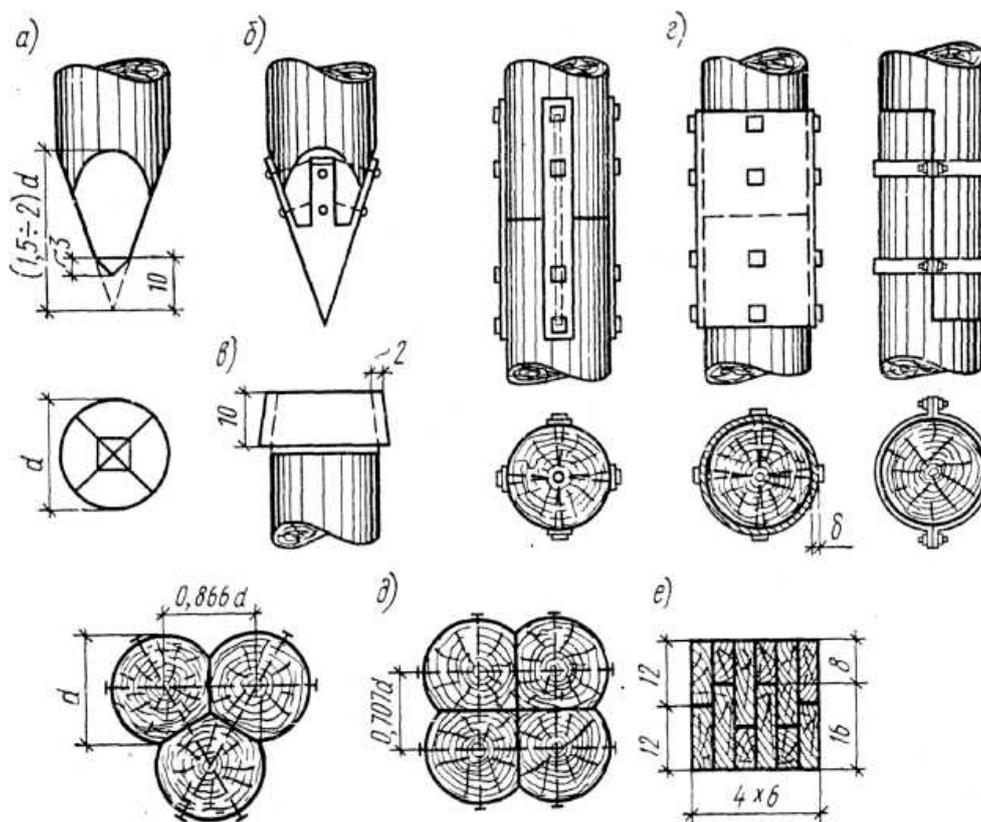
Конструкции деревянных свай (размеры даны в сантиметрах)
